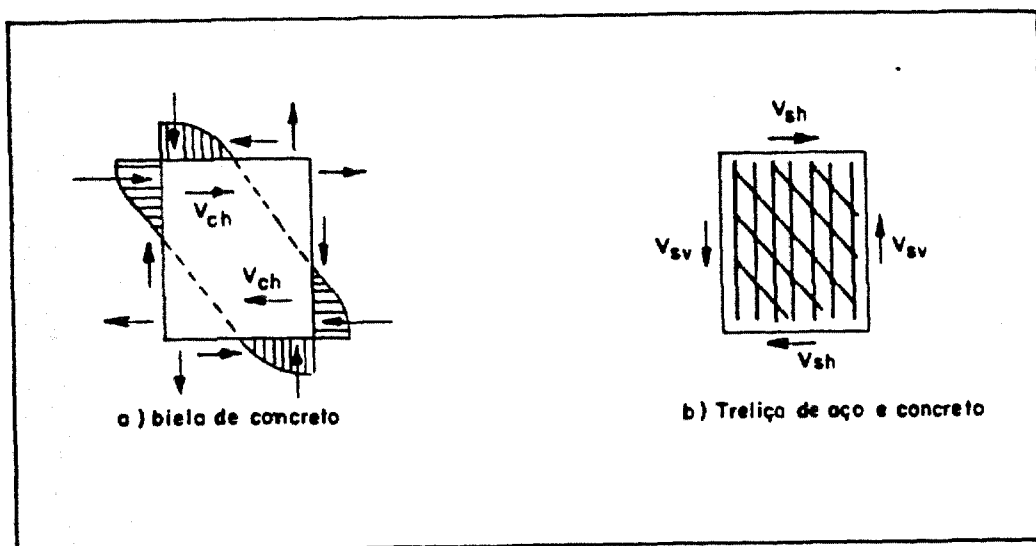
Resistência de juntas vigas–colunas
